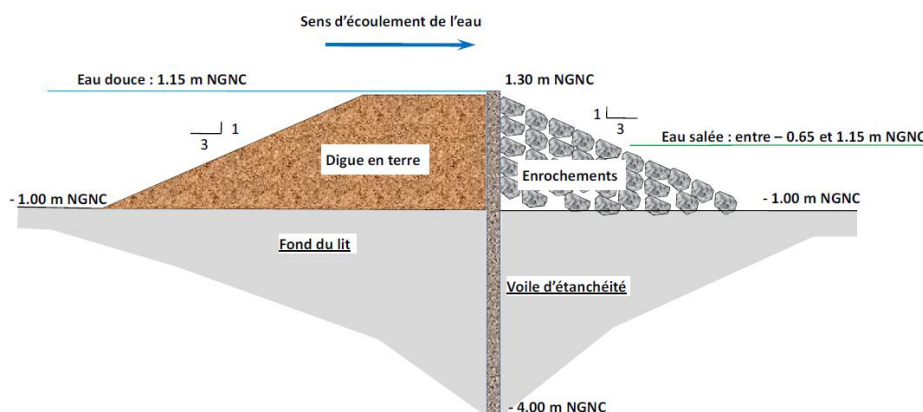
Plan du barrage anti-sel de Tiha (sur le fleuve La Foa) établi d'après les plans de construction, par Agri-Pol (2009).
